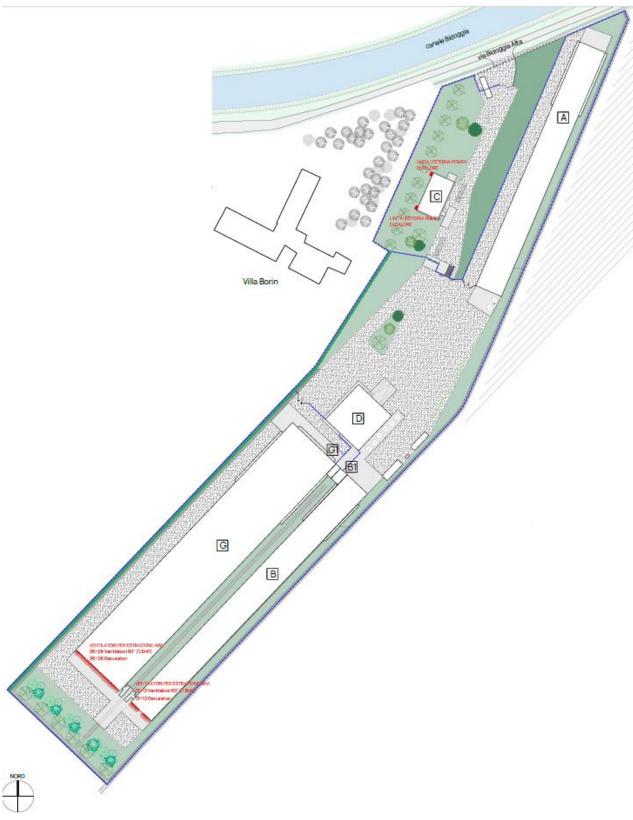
Planimetria dell'allevamento nella configurazione di progetto.
